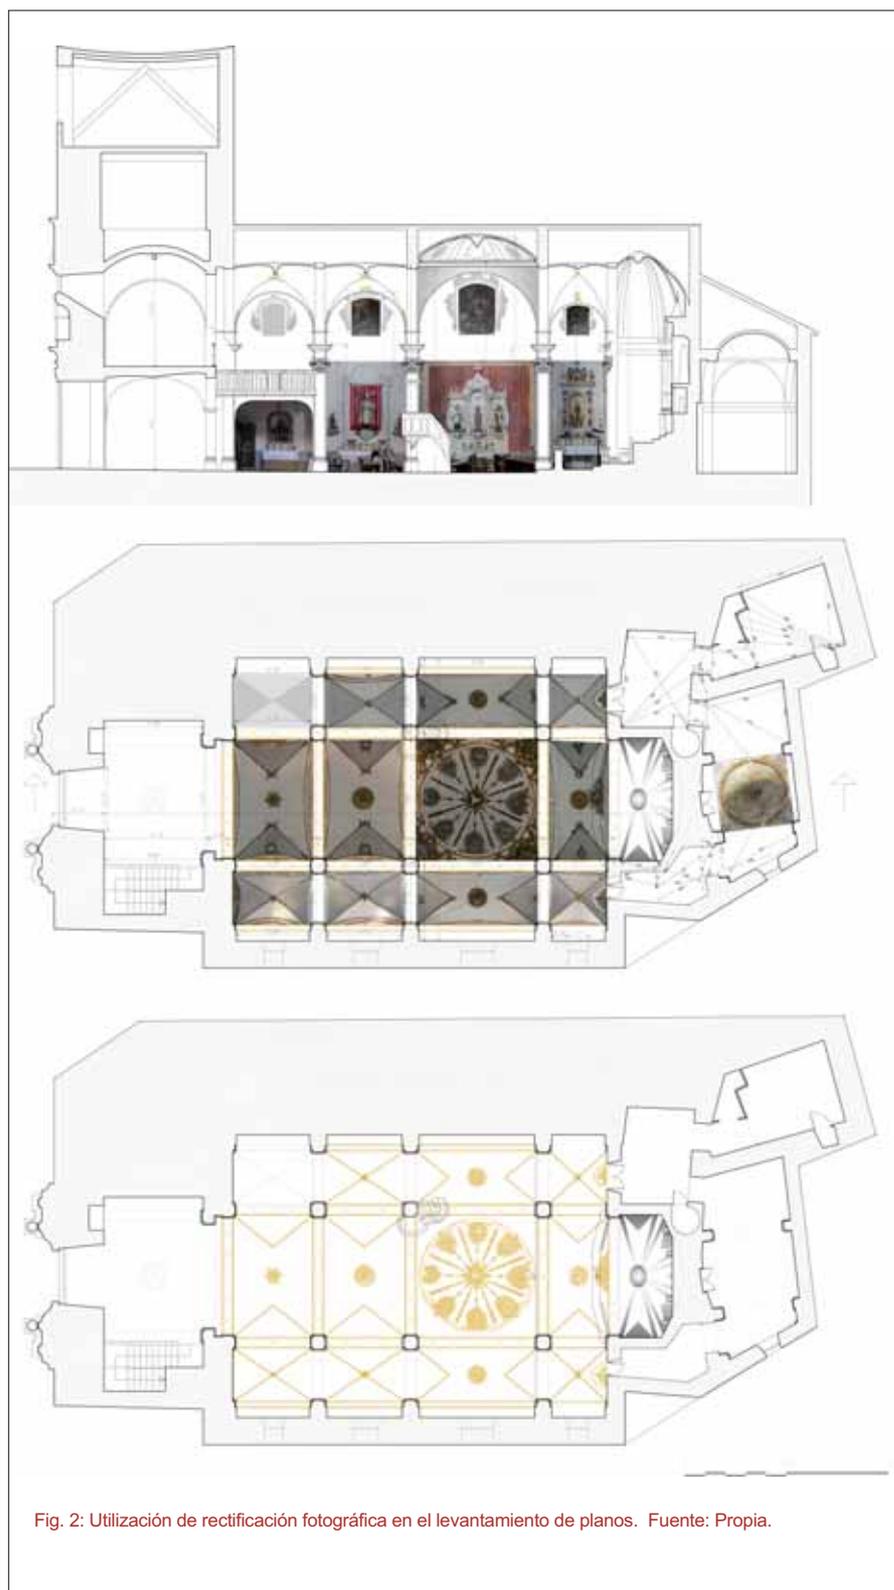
Utilización de rectificación fotográfica en el levantamiento de planos. Fuente: Propia.
